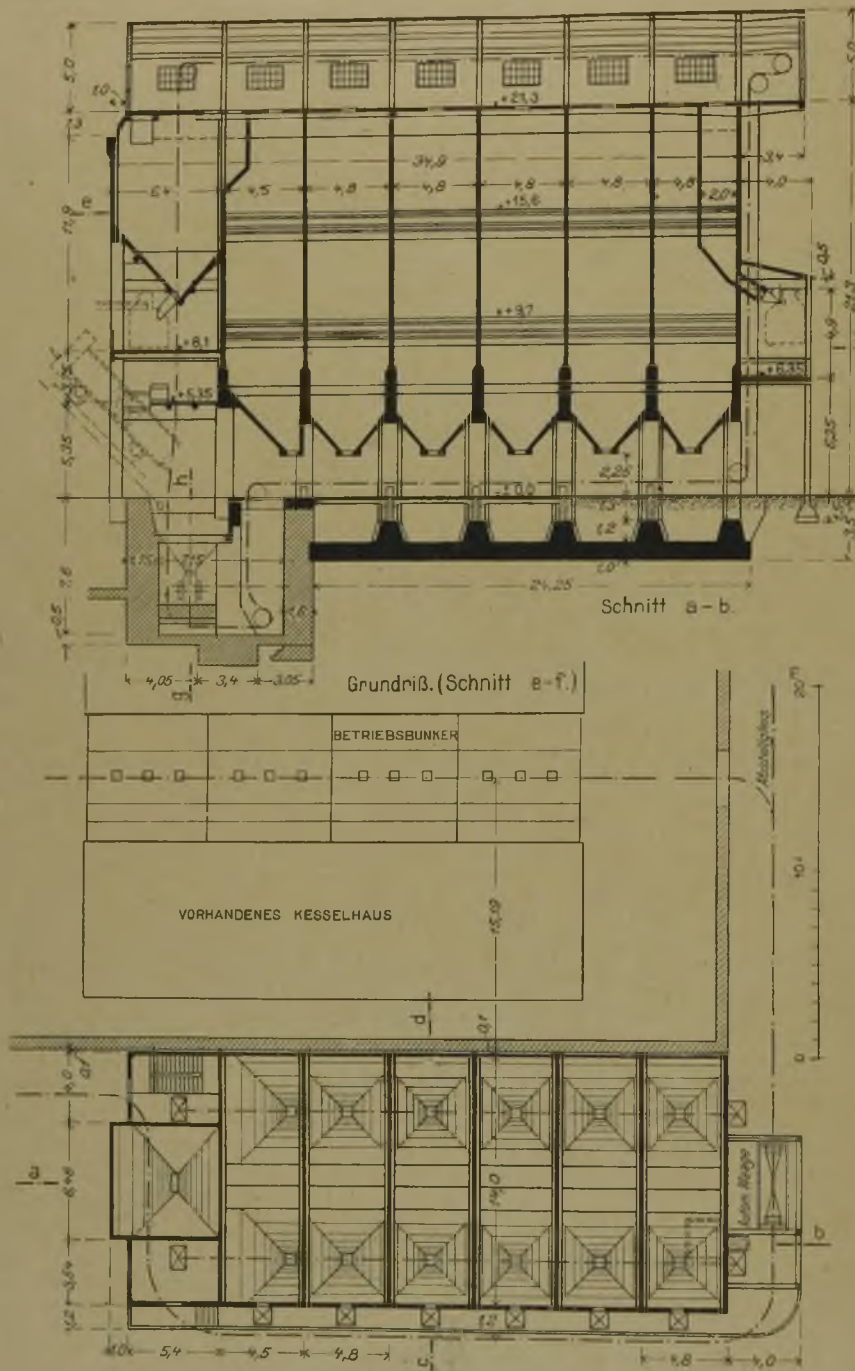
und b. Längsschnitt und Grundriß des Kohlsilos in Duisburg.
